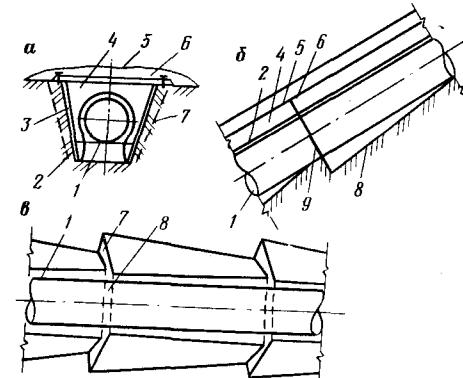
Балластировка трубопровода грунтом с НСМ, уложенного в наклонную траншею:
